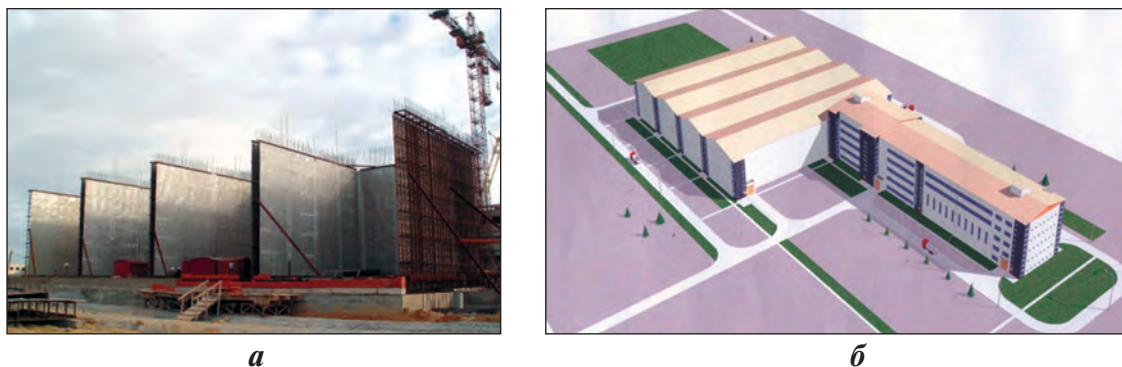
а — строительство комплекса цементирования САО (2011 г.); б — его будущий вид
